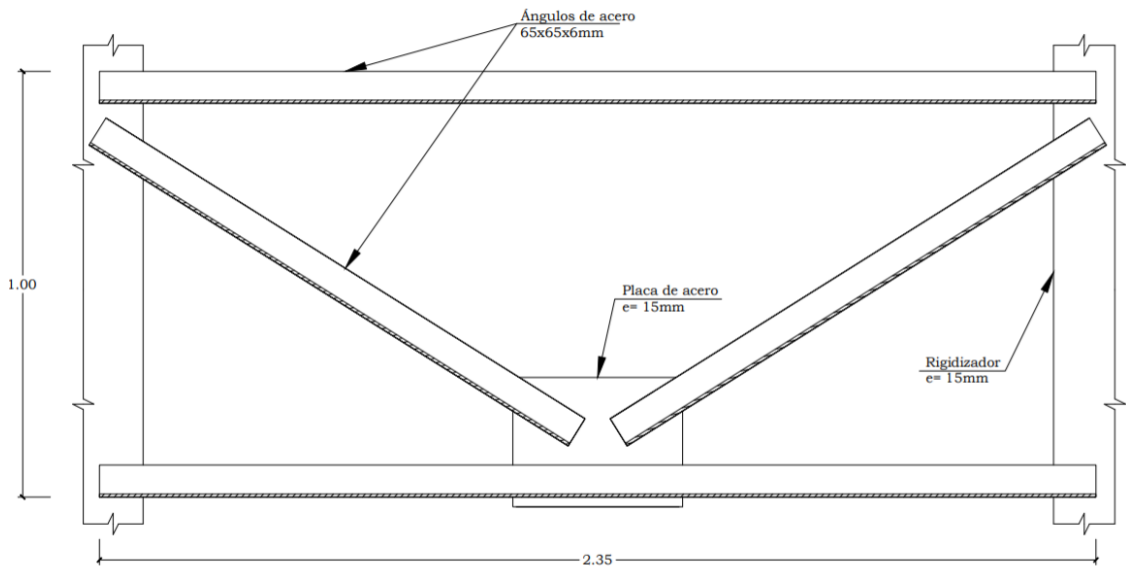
Detalle de arriostramiento a usar en la superestructura. Fuente: Elaboración propia
